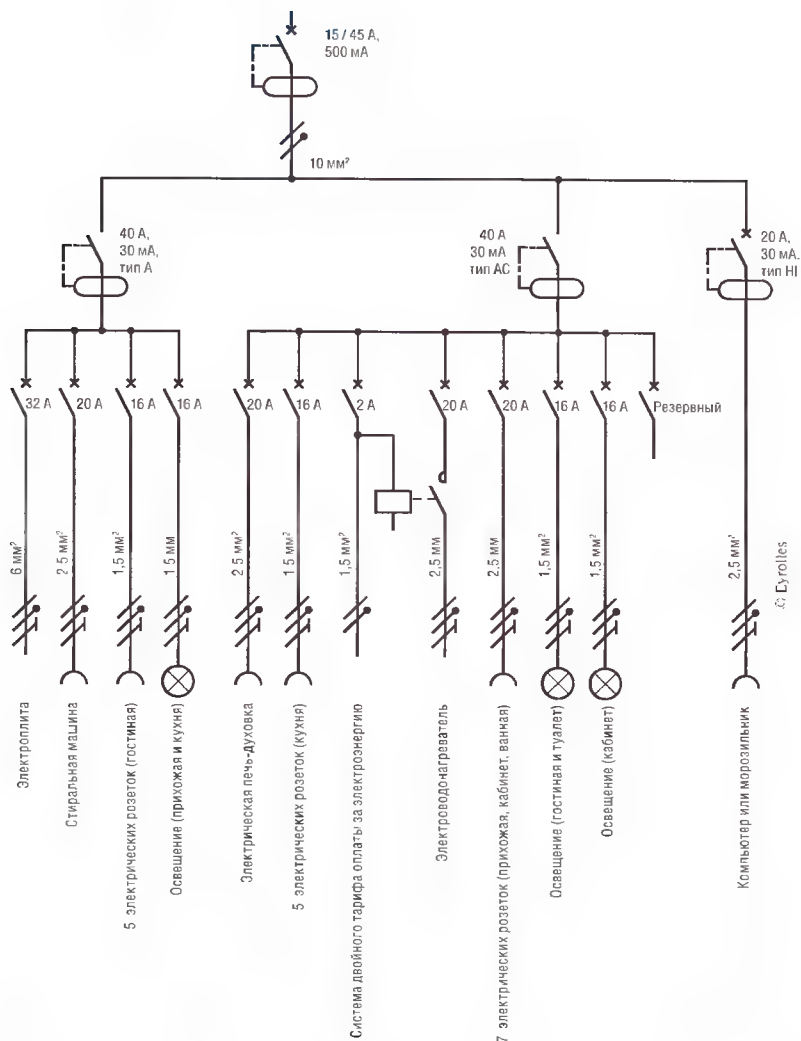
Пример схемы электропроводки для квартиры площадью не более 35 м²
